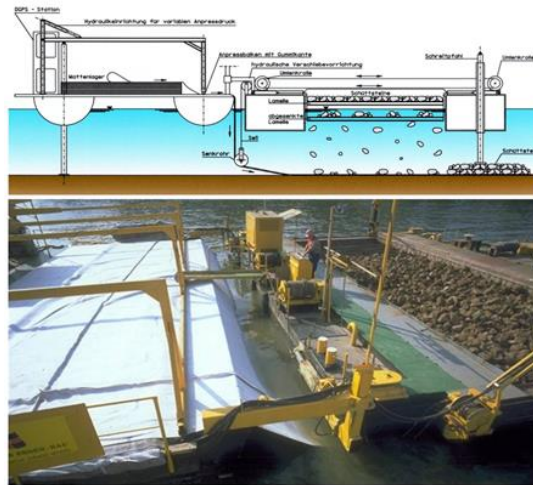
Navire spécialement équipé avec l'installation d'une nappe infinie et la barge pour la chute d'encrochement.
